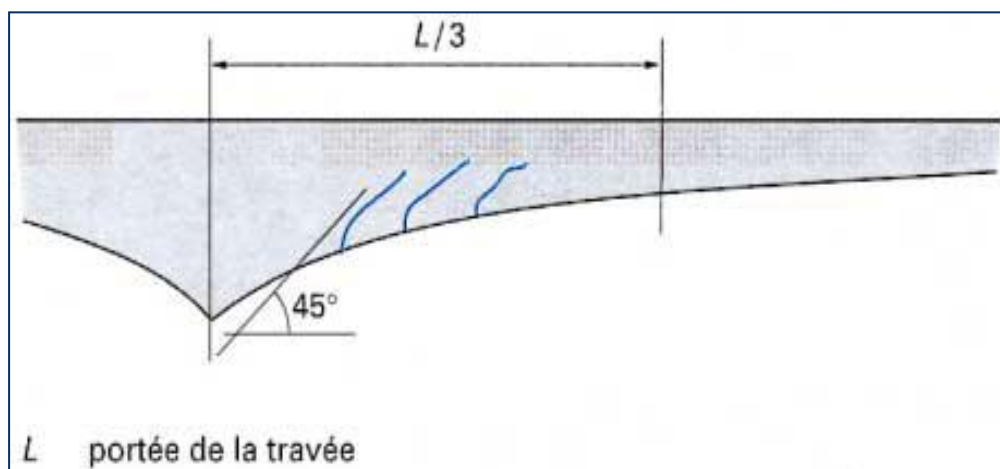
Fissuration d'effort tranchant dans un pont-caisson
